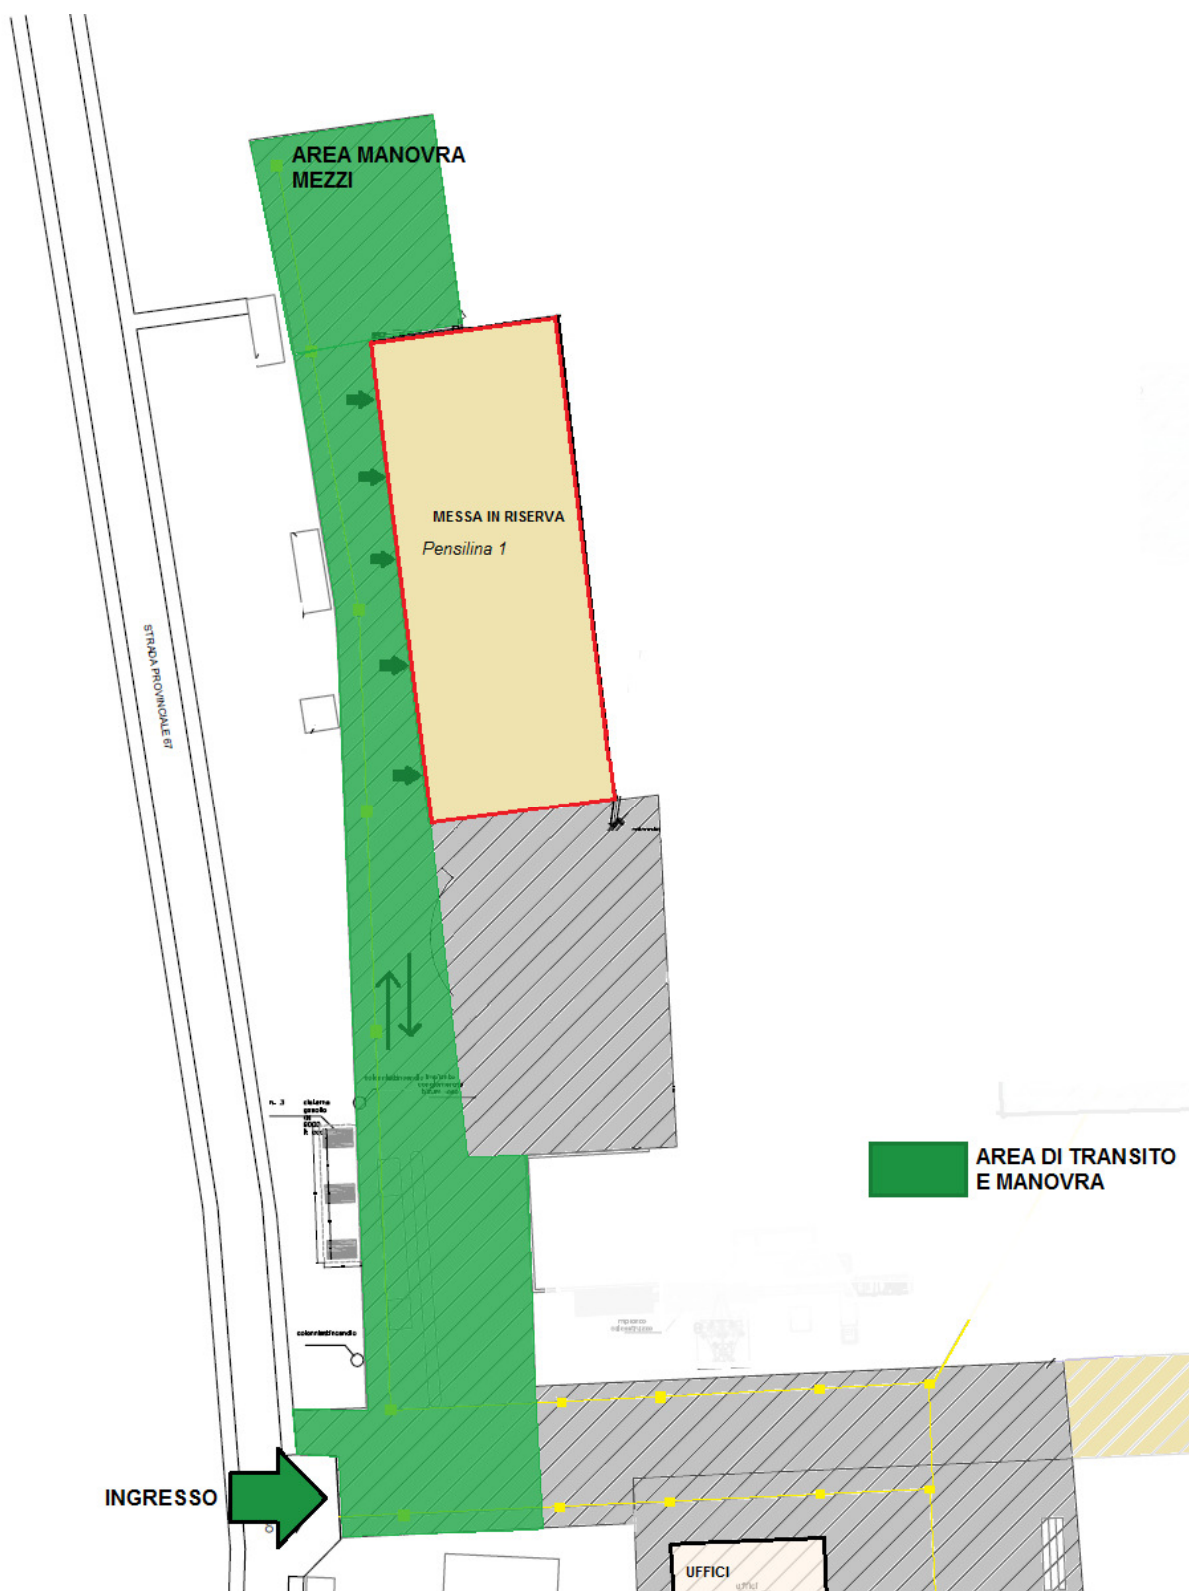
stralcio planimetrico con indicazione delle aree di transito e manovra a servizio della nuova area di messa in riserva
